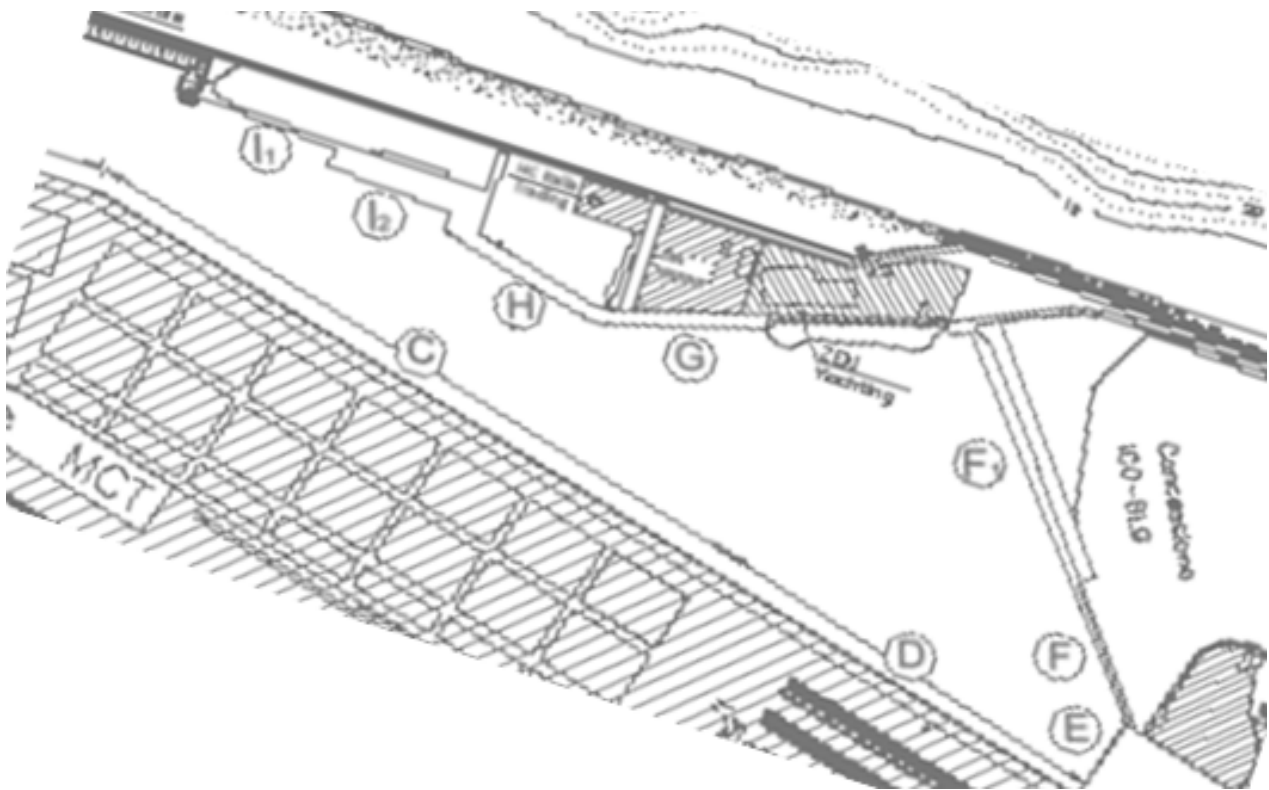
Stralcio planimetrico con l'indicazione della posizione dei banchinamenti esistenti nell'area di interesse
